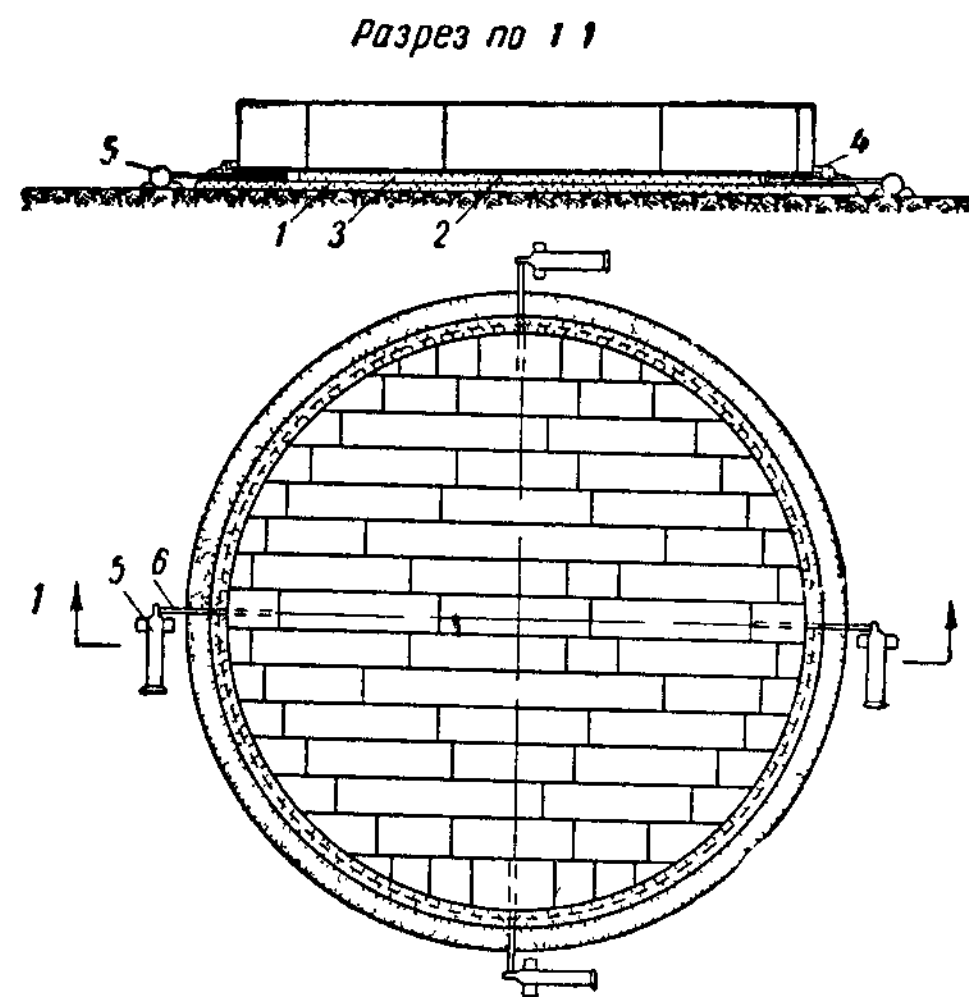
Схема испытания днища при сварке непосредственно на песчаном основании
